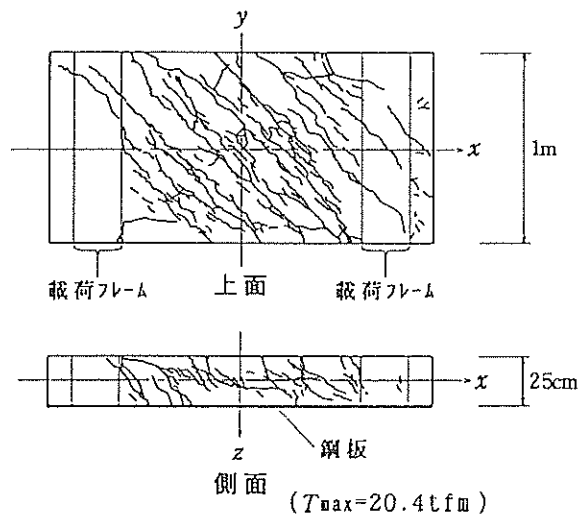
供試体 OS-19-100のひび割れ発生位置
